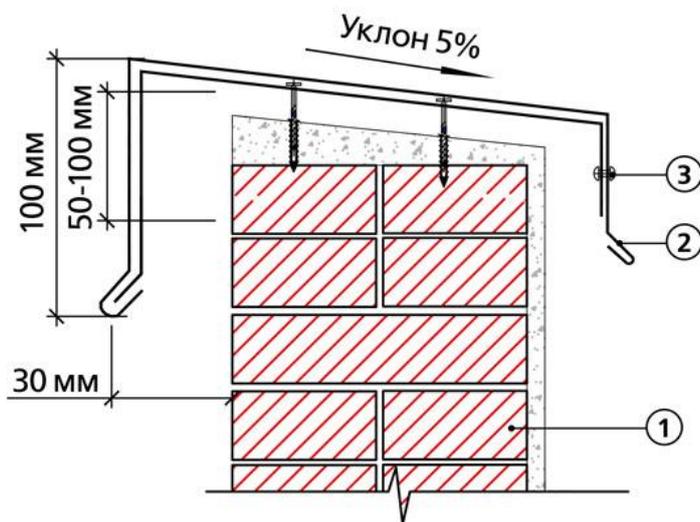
Примыкание кровельного пирога к парапетной стене высотой менее 500 мм:
